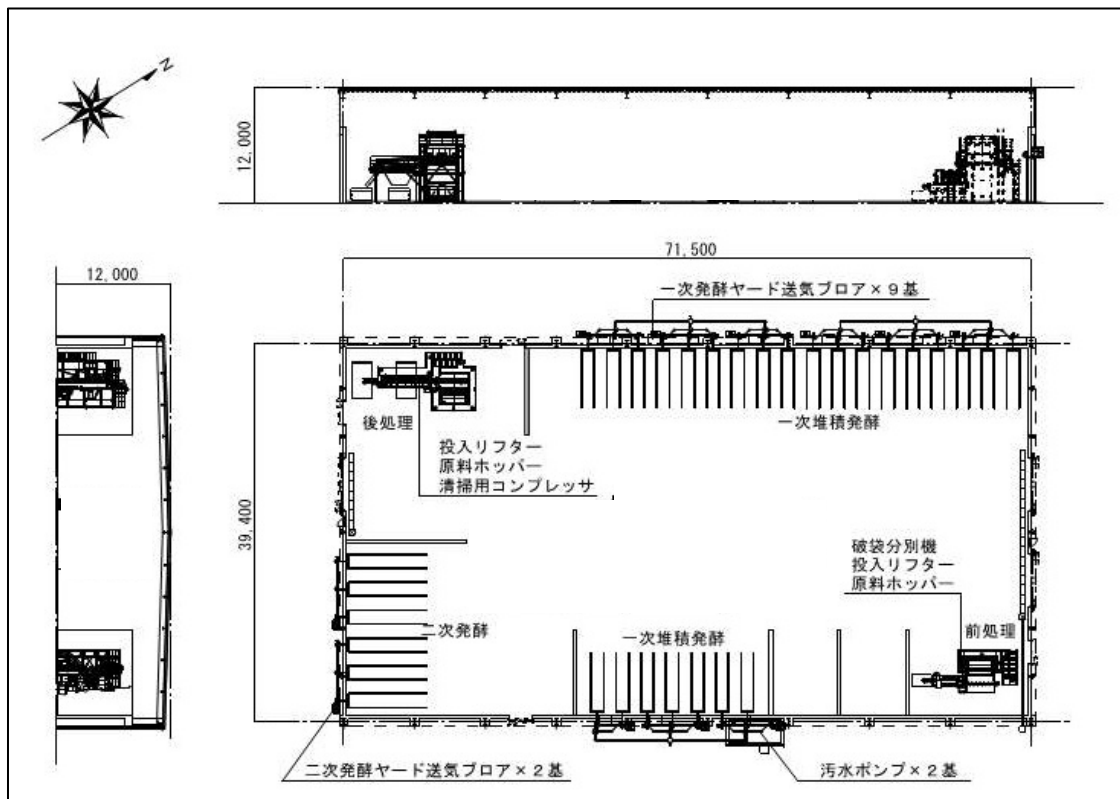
設備機器の平面図・断面図（堆肥化施設）
